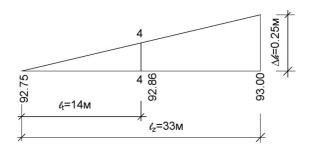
Схема к расчету абсолютных отметок точек на поверхности строительной площадки
